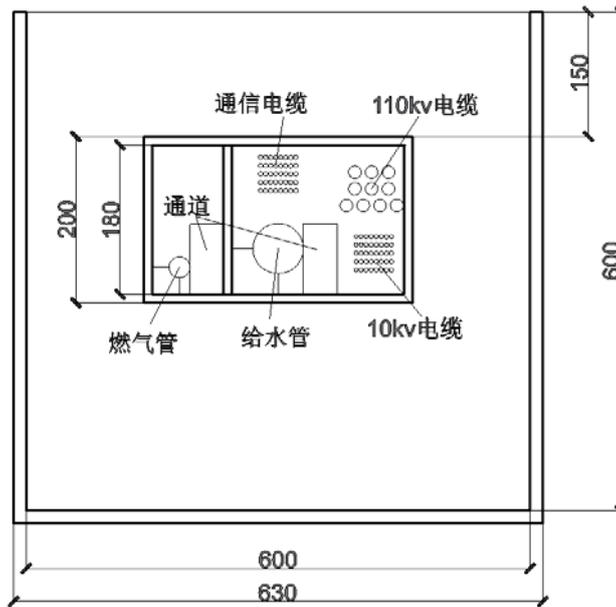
装配式多舱室综合管廊模型横断面示意图（单位：mm）
